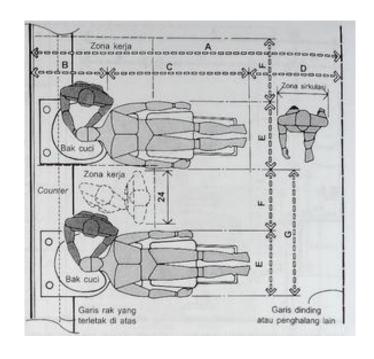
Studi Antropometri Ruang Retail 4
